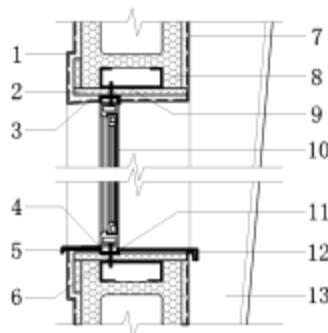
门窗框与水平芯肋连接组合及保温防火构造示意
